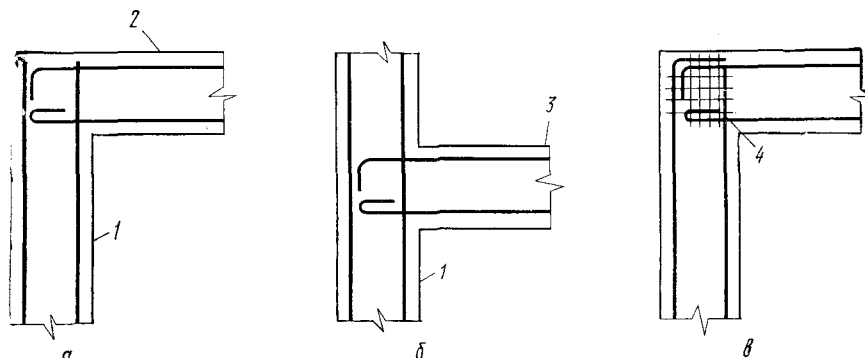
Некоторые типы соединений балок с колоннами в железобетонных каркасах
